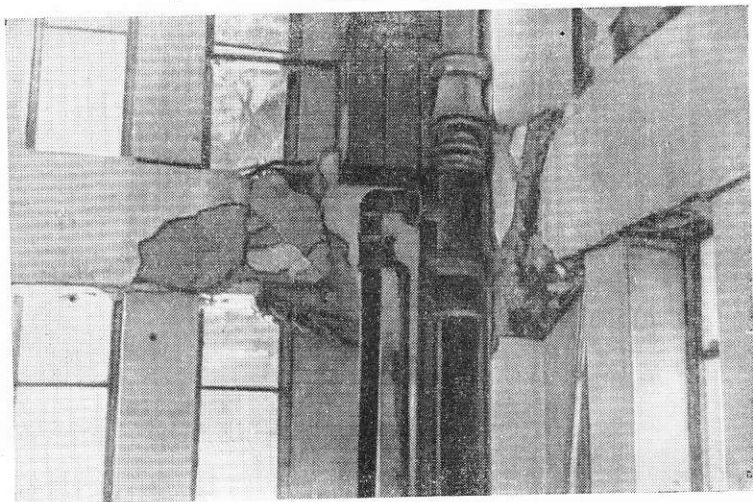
Разрушение бетона в железобетонных стойках и ригелях рам
